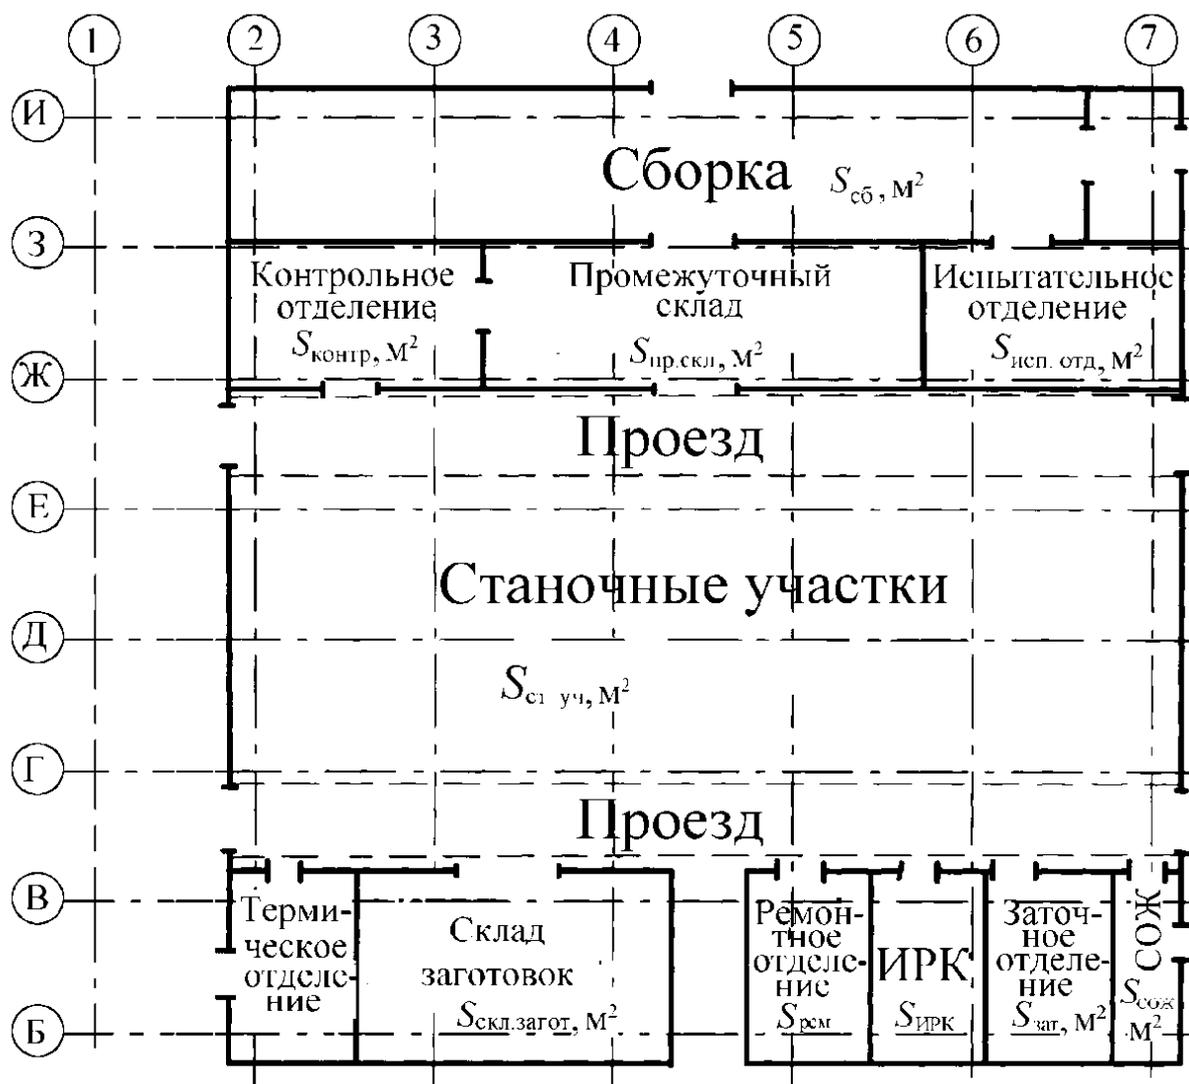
Пример компоновки обрабатывающего и сборочного цеха
